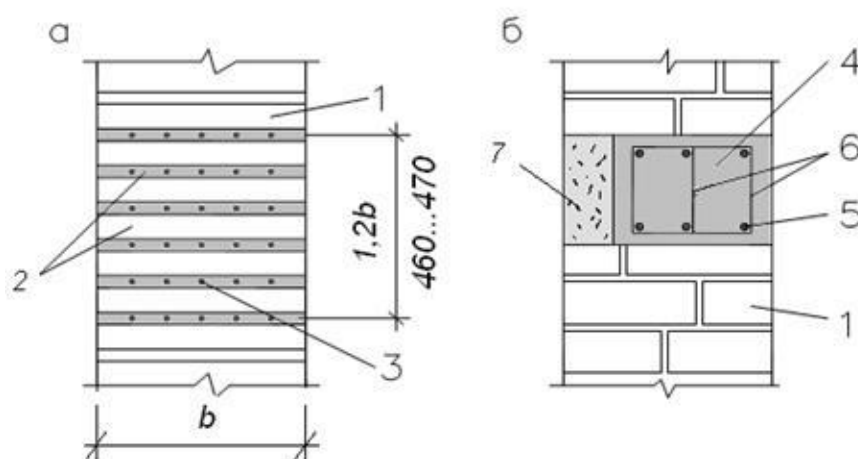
Усиление стен здания поясами: *а* – армокаменным; *б* – железобетонным:
